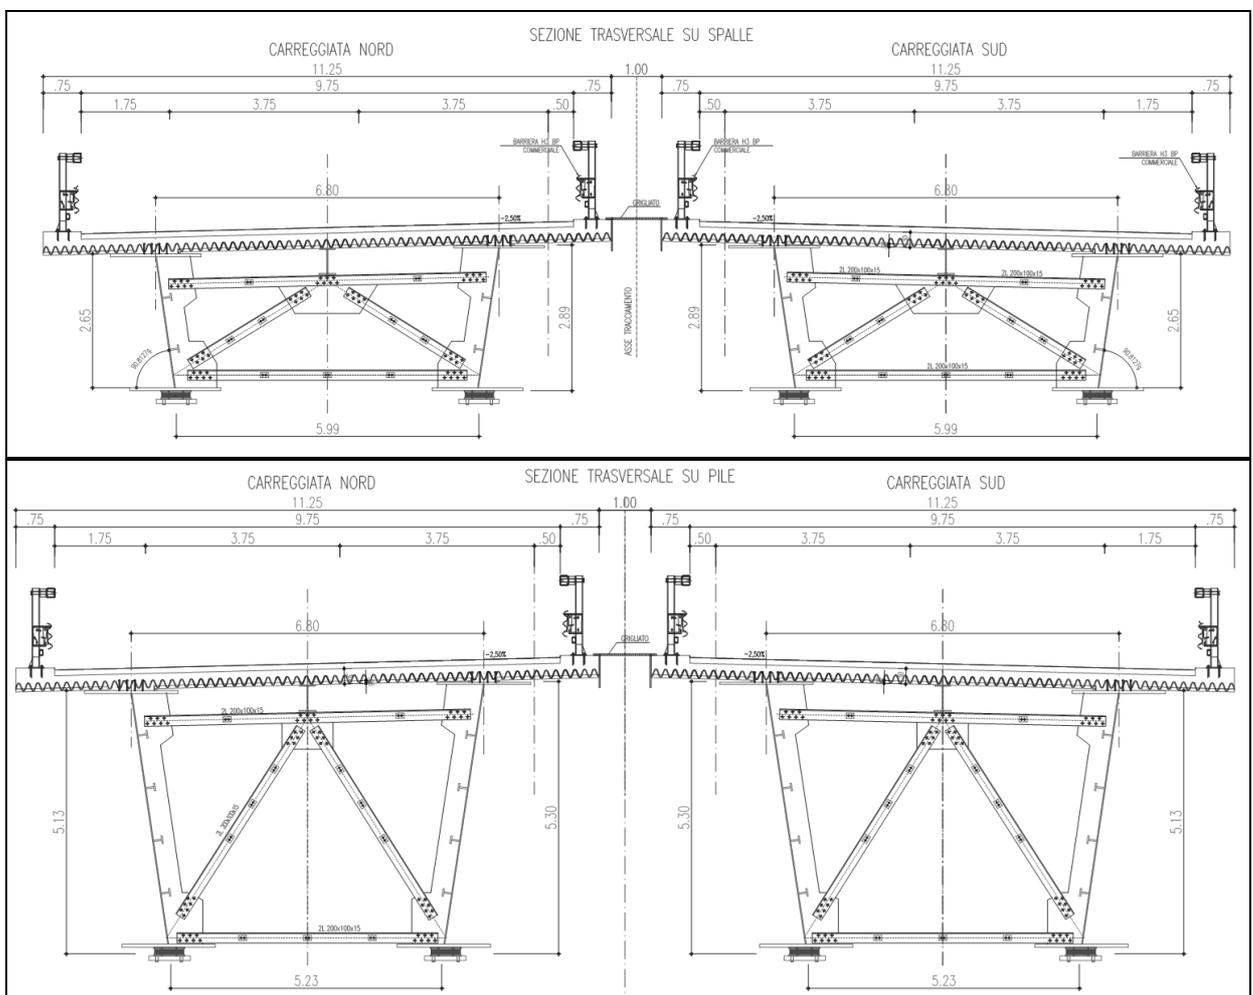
Sezione trasversale in asse spalle (sopra) e pile (sotto)
